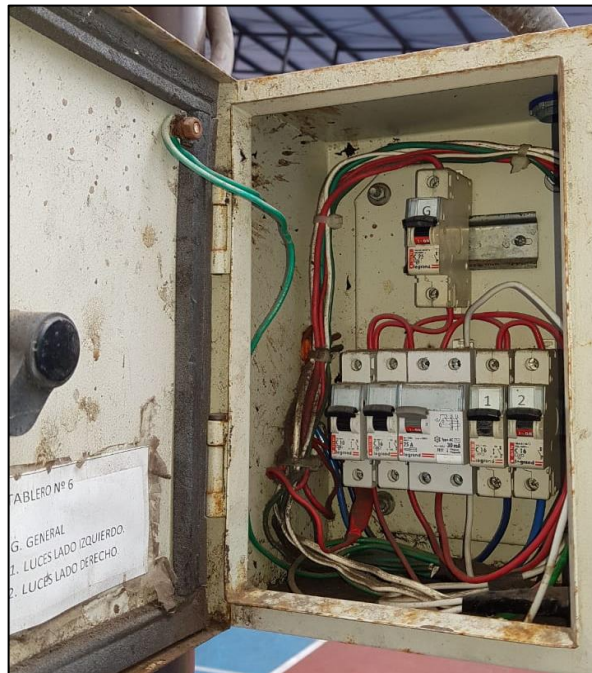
TDA 6 Multicancha, condición subestandar, constante cortocircuito por sobrecarga, modificado para anexar salas de clases, enchufen alledaño en mal estado puenteado directo desde protección.
